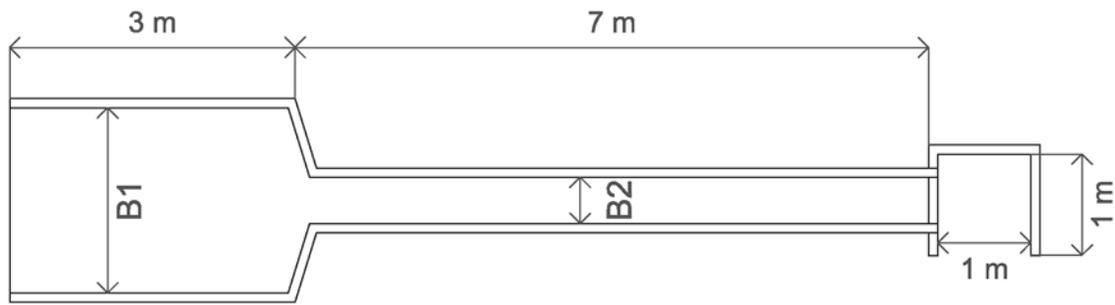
Planta y elevación de estructura y mecanismo de compuertas de salida y sus principales dimensiones.
